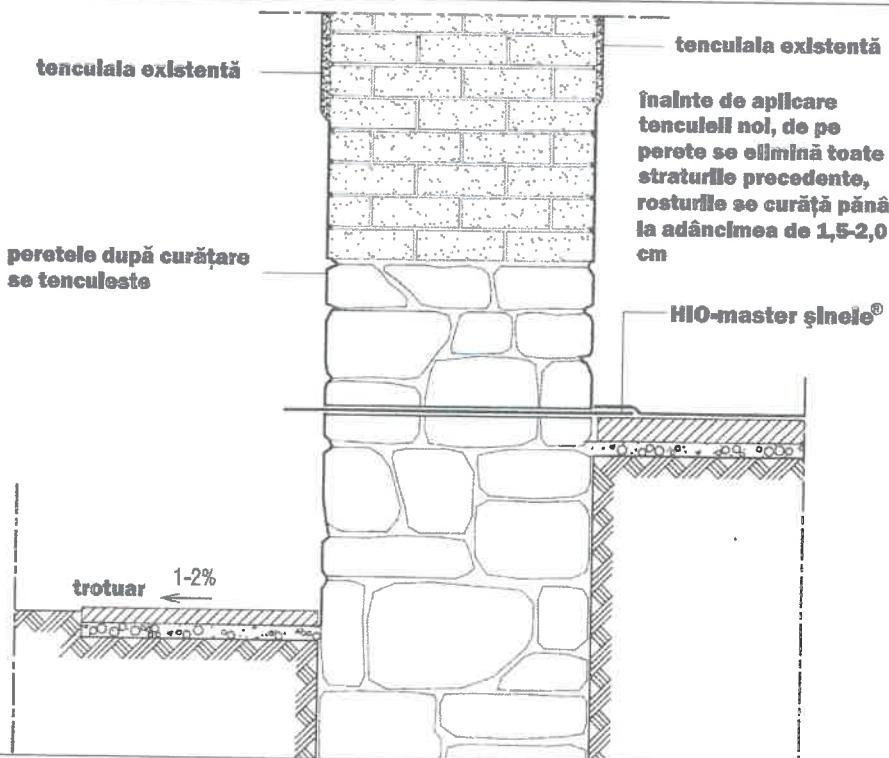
Detaliu hidorizolare la fațadă exterioară
